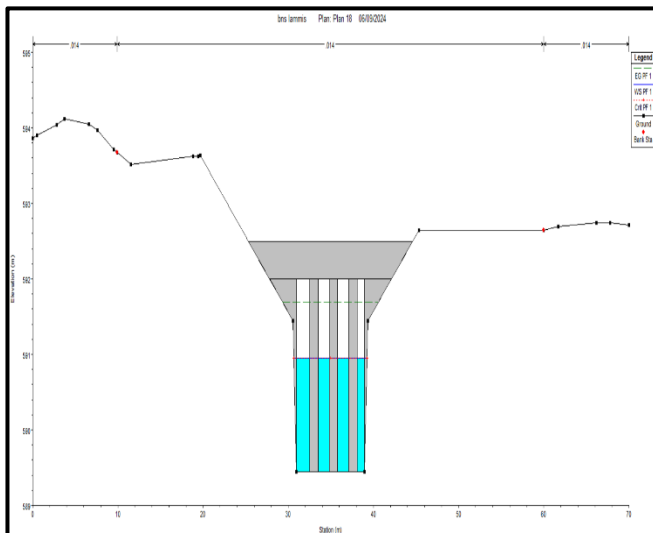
Section transversale des dalots au Pont N°1 (O Aouaoudja)
